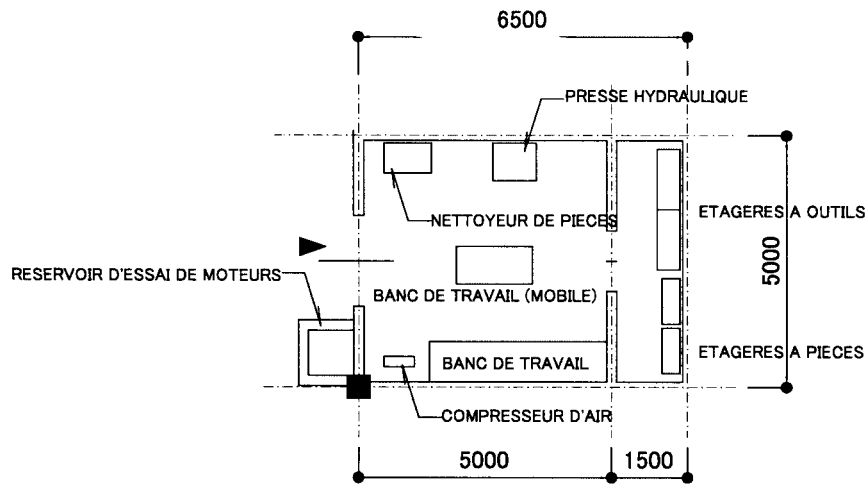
Plan planimétrique du bloc d'atelier mécanique
